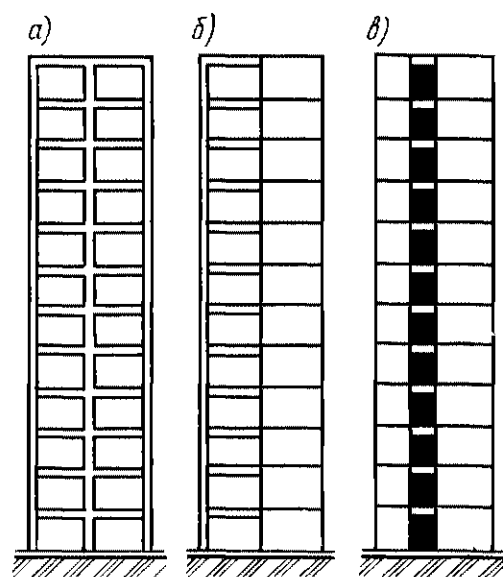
Основные вертикальные конструкции многоэтажных зданий:
